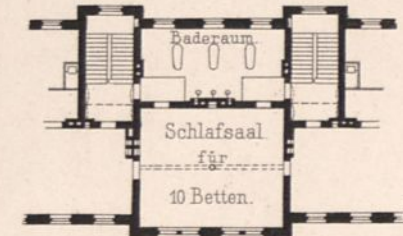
Krankenhaus B. Mitteltheil vom Grundriß des Obergeschosses.
